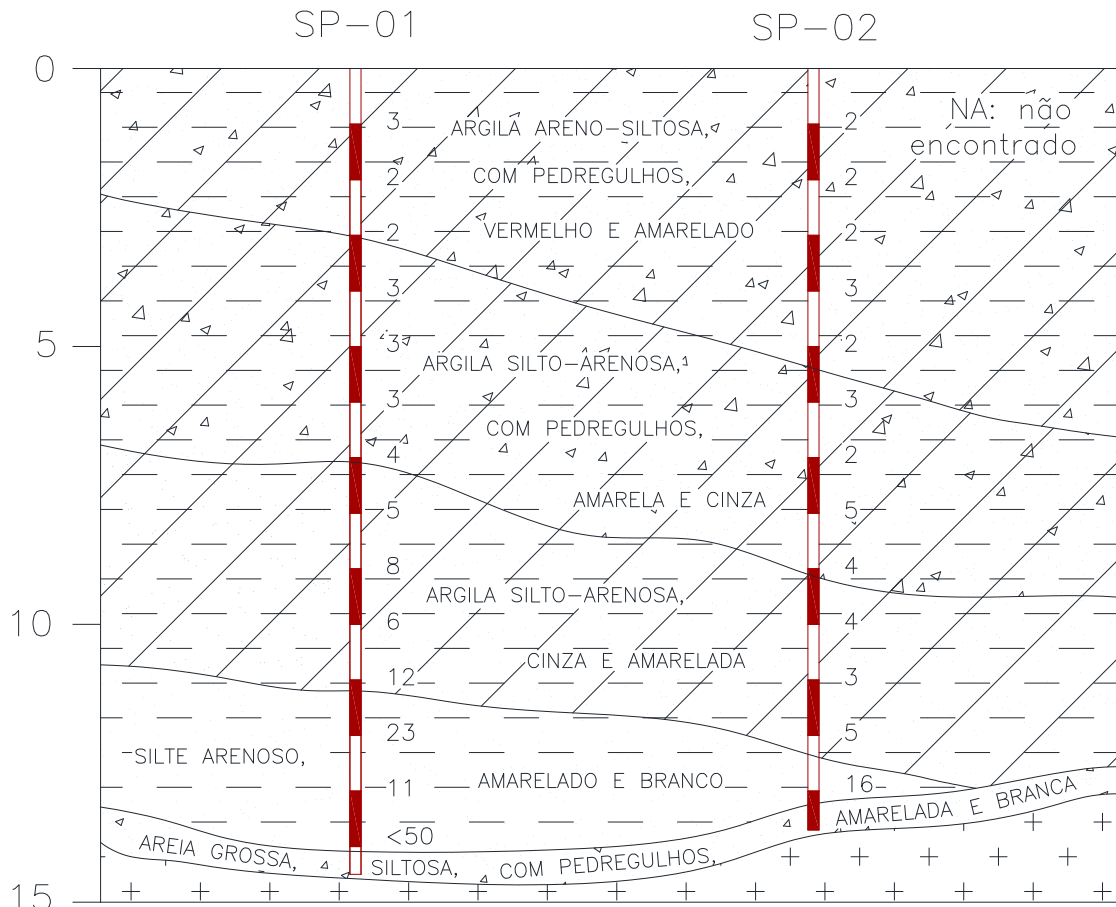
Perfil geotécnico provável da Área 2 (medidas em metro).
